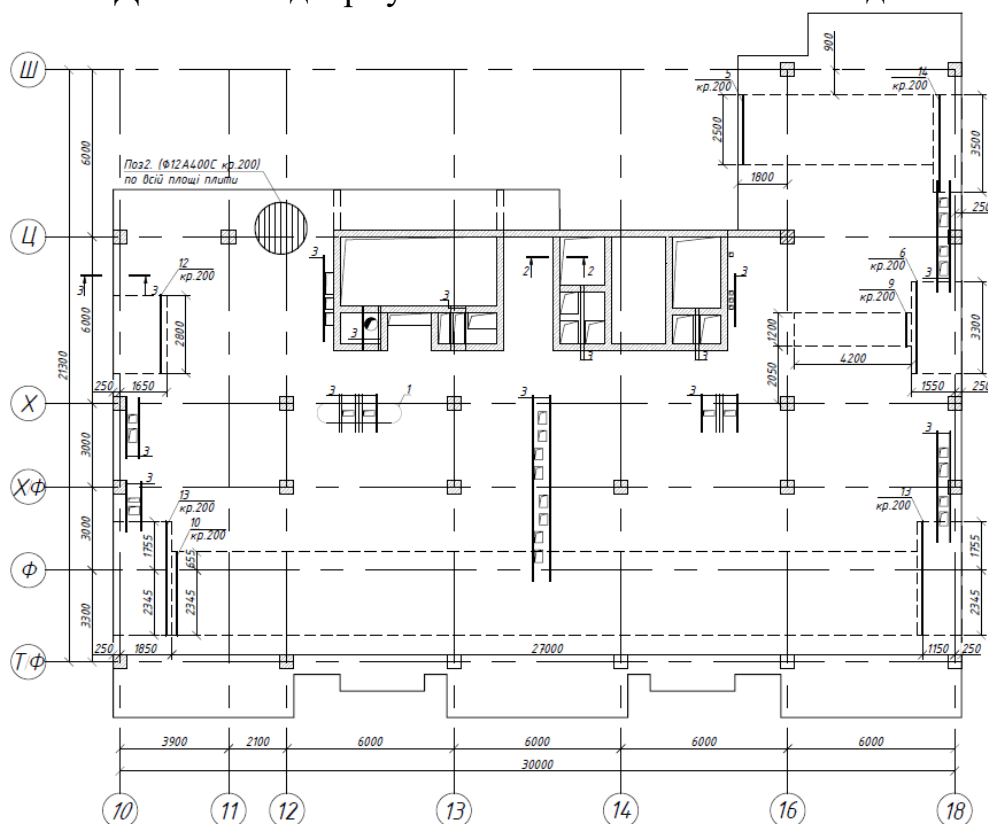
Схема розташування нижньої арматури вздовж осі Y.
